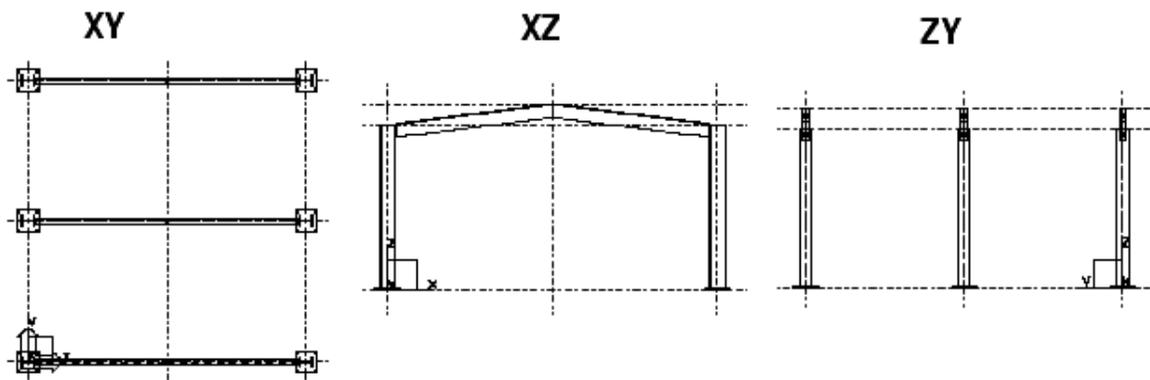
Opciones de plano de vista para las vistas básicas
